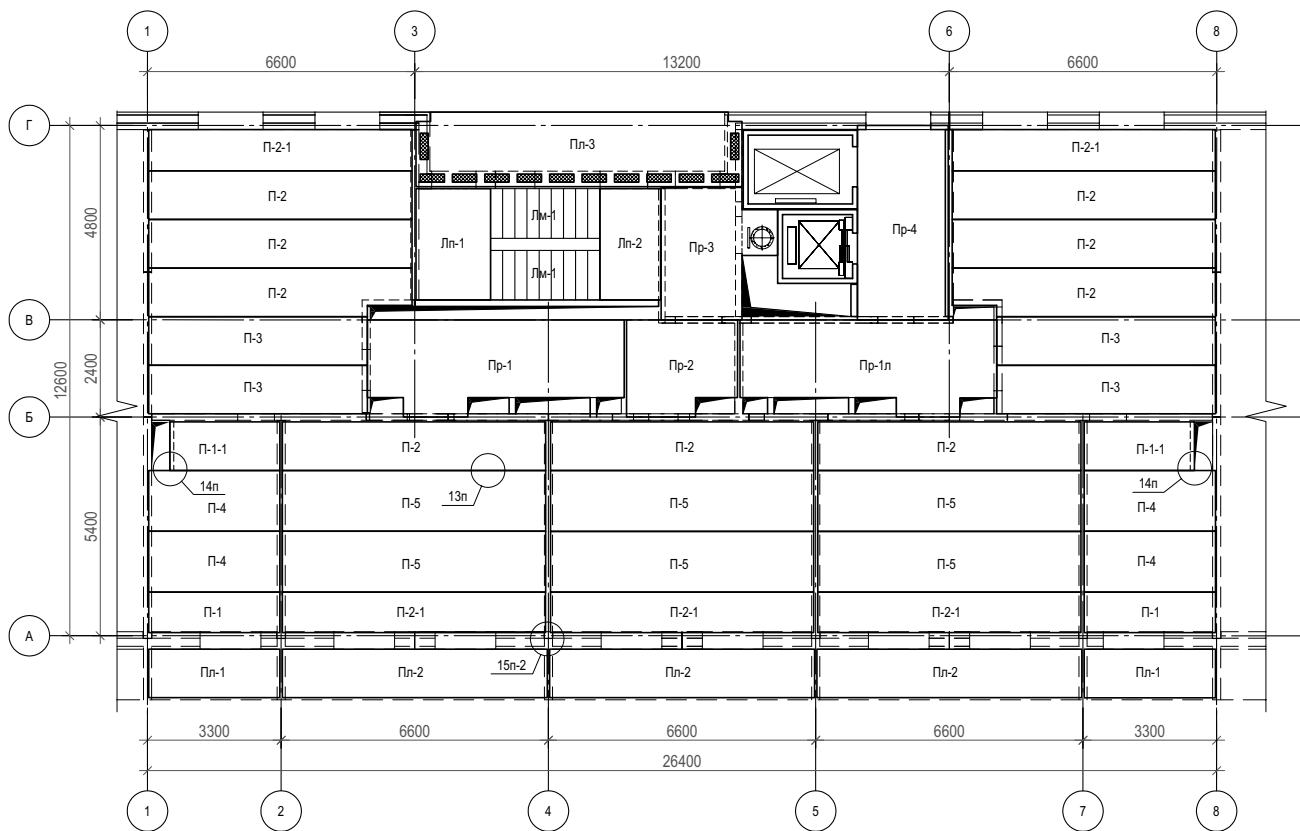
Широтная секция с «лежачей» лестницей и поперечными несущими стенами позволяет в пределах несущих стен менять планировочные решения квартир
